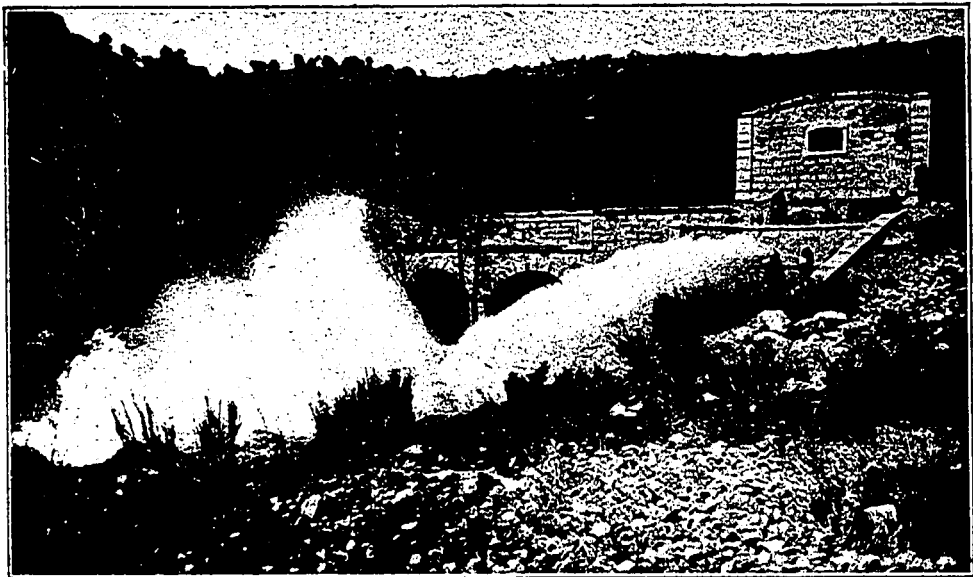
Sifón del Guadalix. Desagüe de fondo. Kilómetro 38
